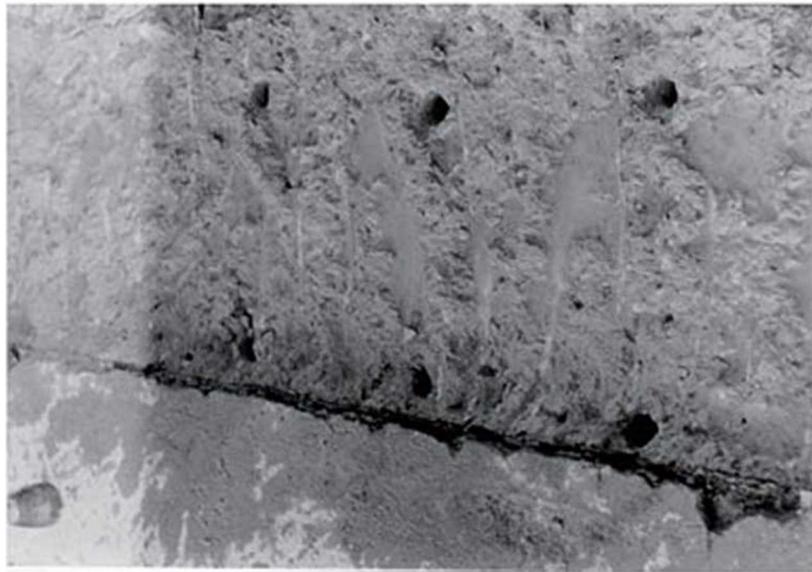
Furação para ancoragem de barras (RIPPER, 1998)
